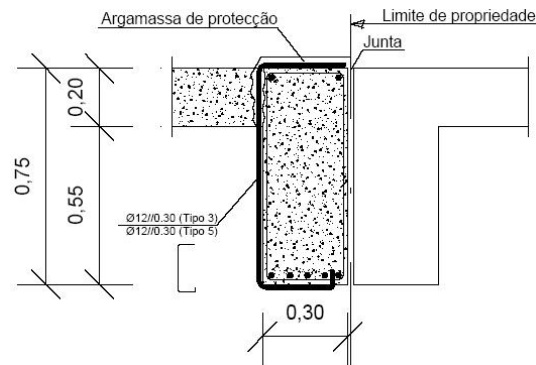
Proposta final para reforço ao corte das vigas do pórtico 8 e 15.
